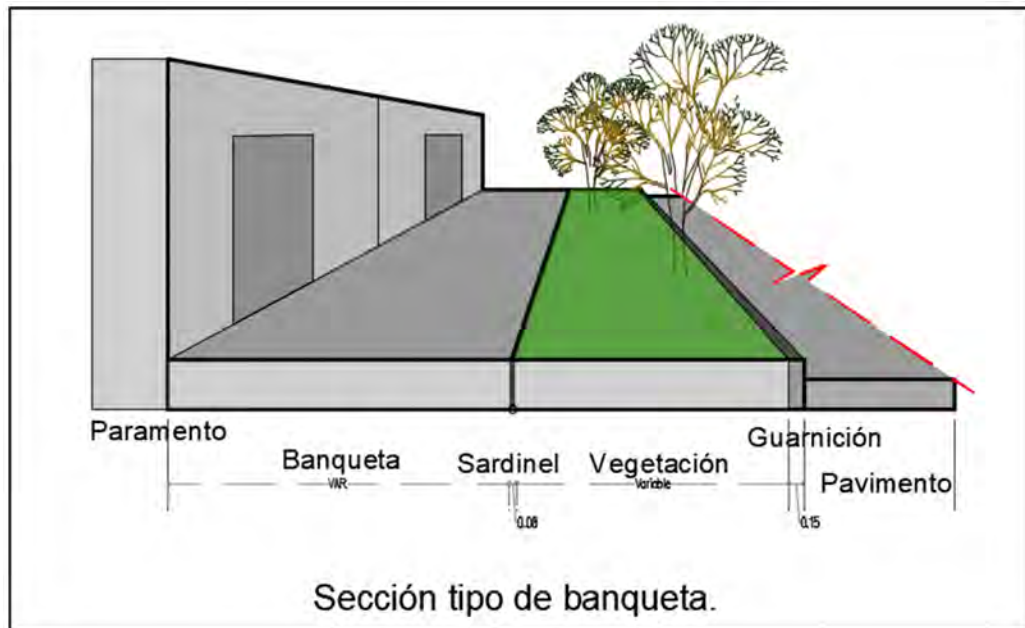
1. Sección tipo de banqueta, con franja de fachada, franja de circulación, franja de mobiliario y franja de guarnición.
